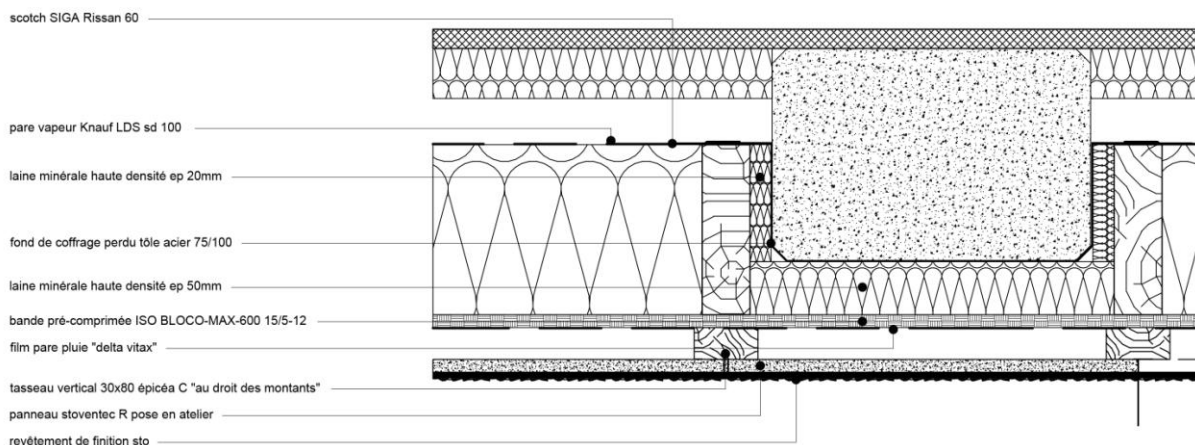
détail en plan de l'assemblage poteau / façade bois (extrait carnet de détail EXE Satob)
